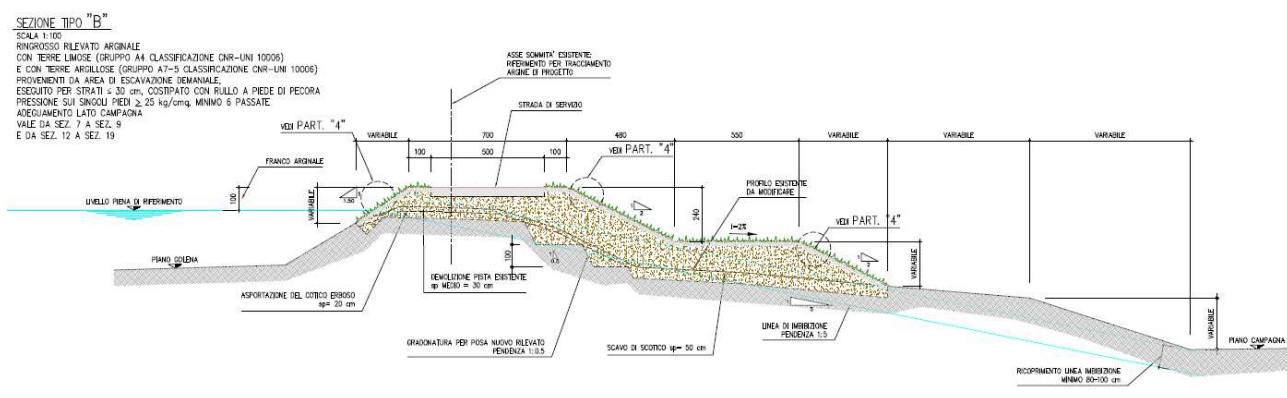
Sezione tipo B – Adeguamento lato campagna
